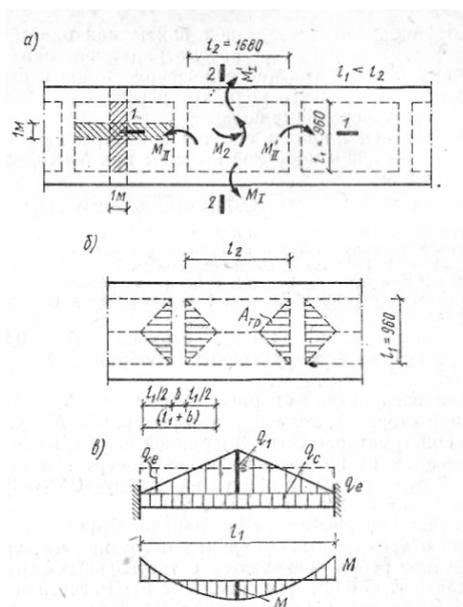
К расчету плиты, опертой по контуру, и поперечных ребер панели перекрытия: а – план; б, в – загрузка и эпюра M поперечных ребер
